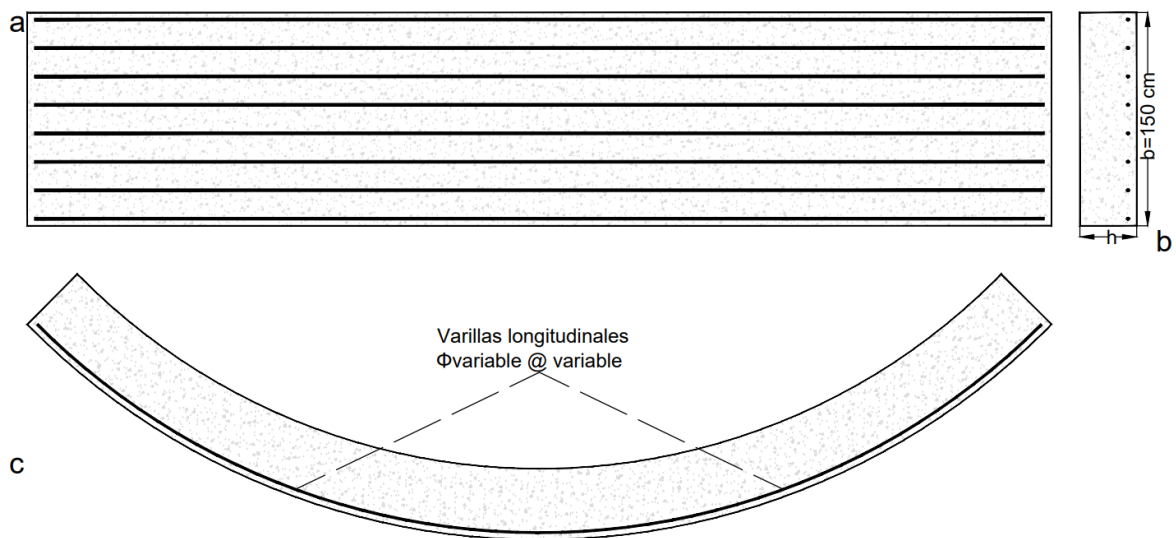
Vista superior (a), transversal (b) y frontal (c) del refuerzo de una dovela de hormigón armado.
